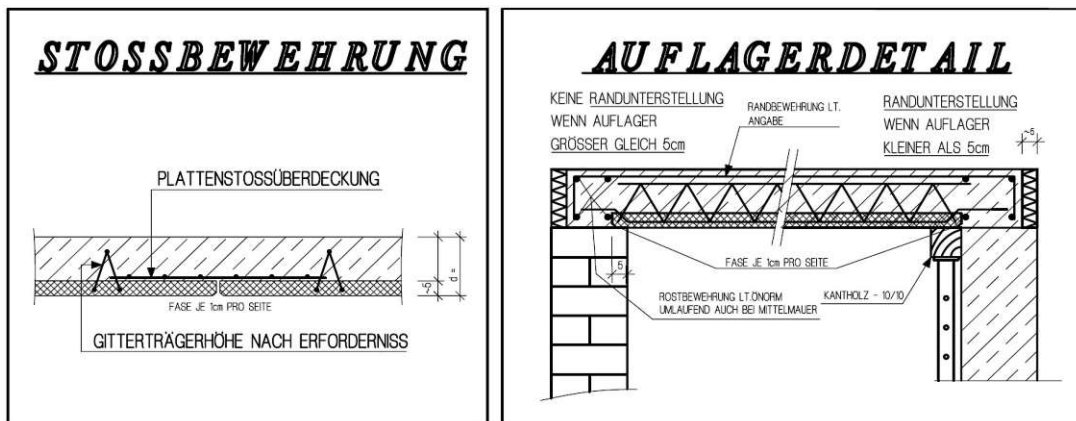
Stoßbewehrung bei Plattenstößen und Auflagersituation bei Elementdecke<sup>28</sup>
